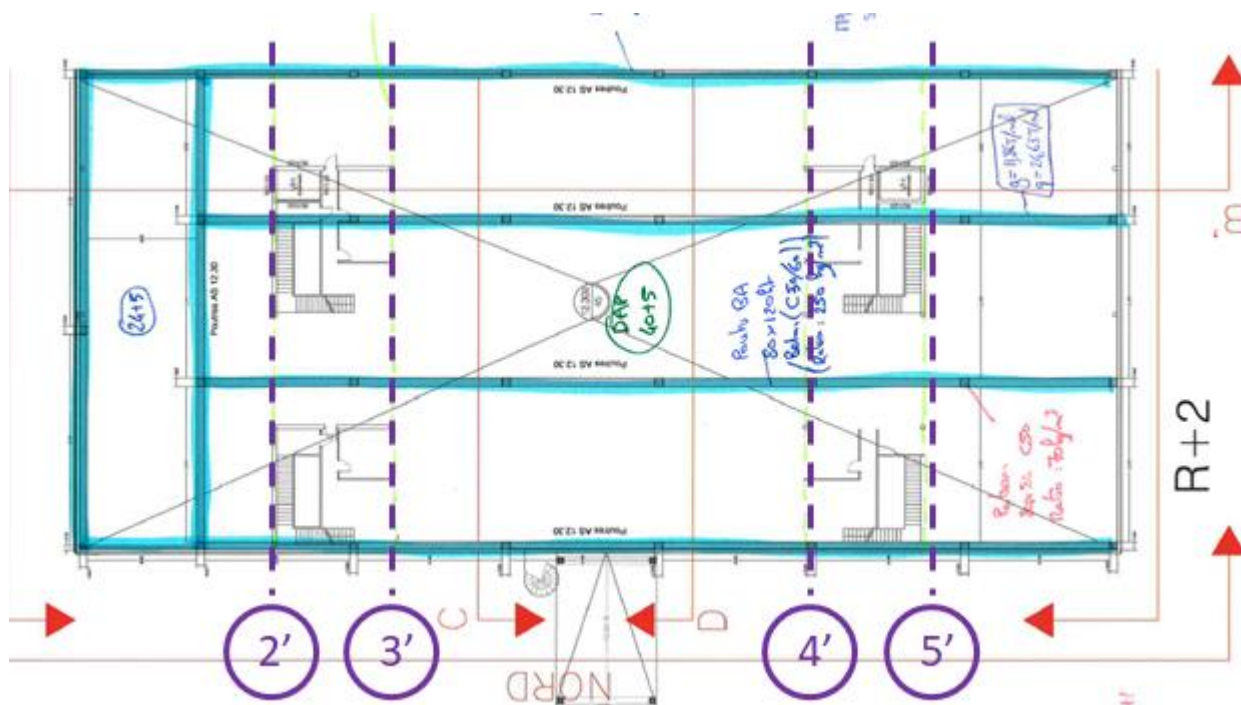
Exemple de la structure porteuse du plancher du R+2
